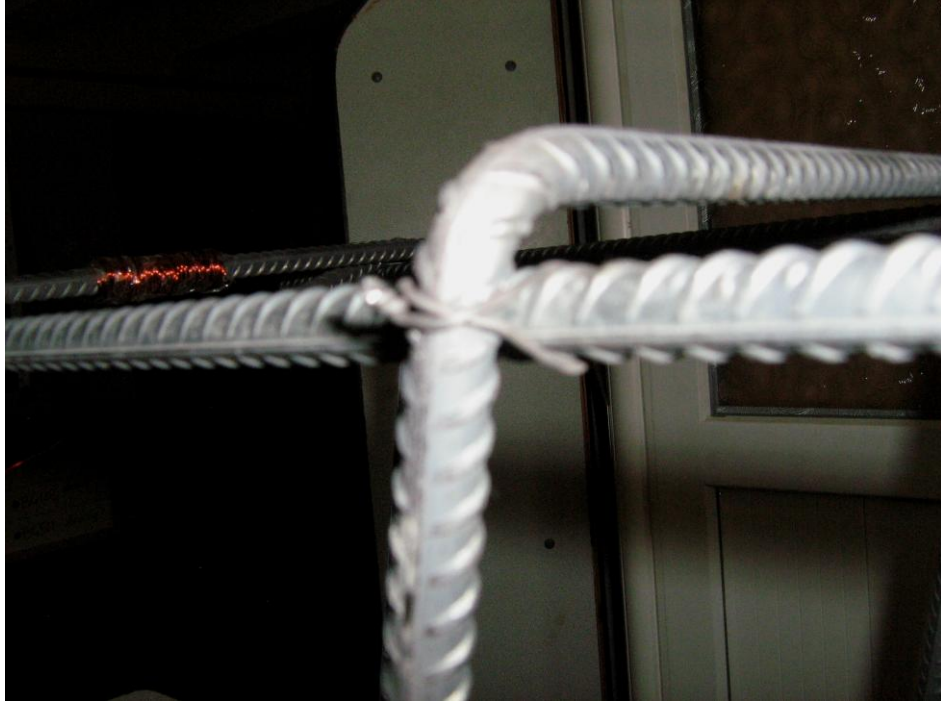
Bir Betonarme Kolonunun Örnek Yapısı
